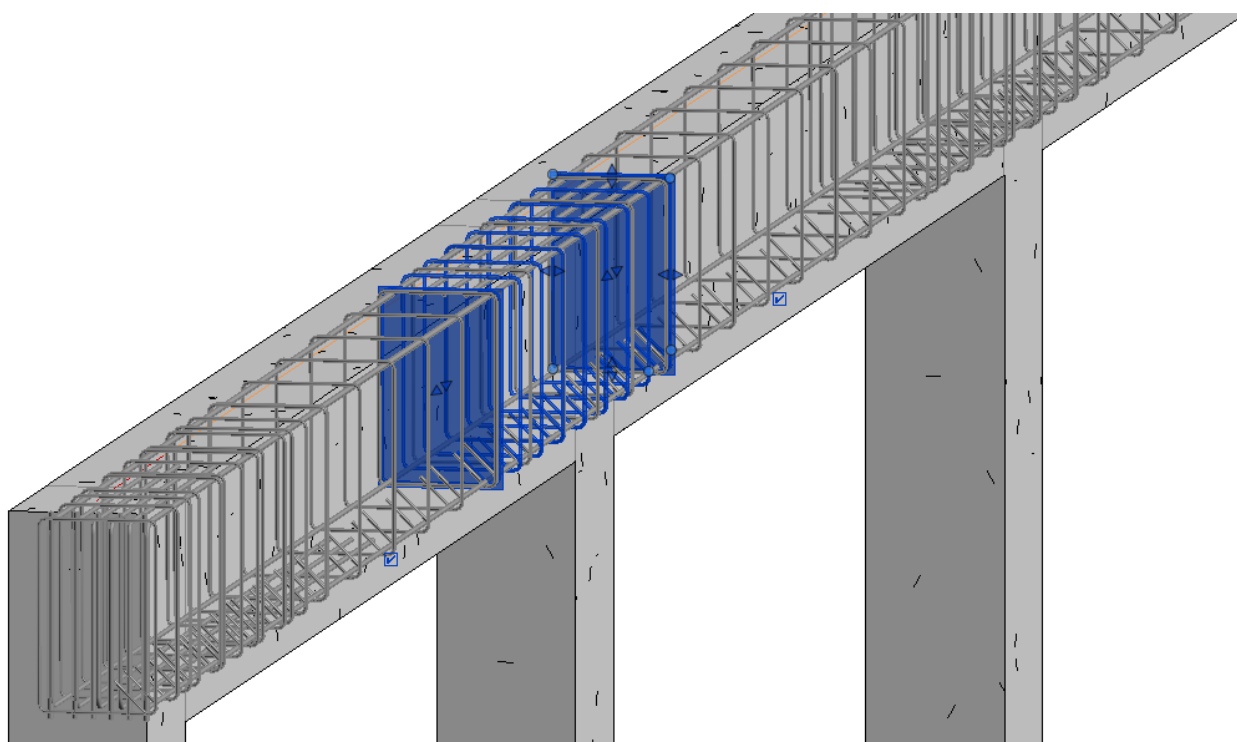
Armaduras geradas automaticamente e grupo de estribos de reforço selecionado (Fonte: Autor).
